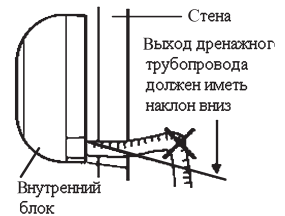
Особенности монтажа дренажного трубопровода
